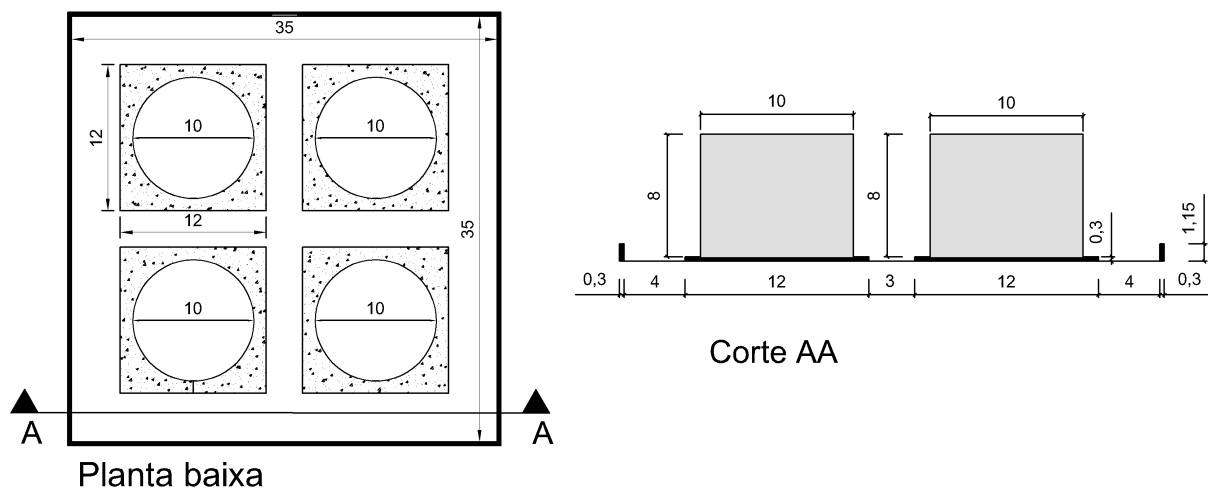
Planta baixa e corte referente a um parque de tanques verticais não isolados resfriados por linhas manuais e/ou canhões monitores.
